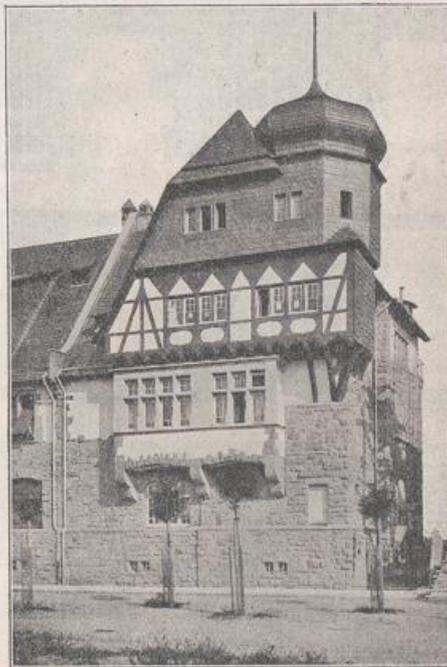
zeigt ebenfalls eine von dem Verfasser in Bingen a. Rh. ausgeführte bewegtere Giebelbildung, bei der das Konstruktionsprinzip soweit durchgeführt ist, daß die untere Kante der Hausteinabdeckung des Giebels mit der Dachfläche parallel geht, bzw. mit dieser zusammenfällt.
